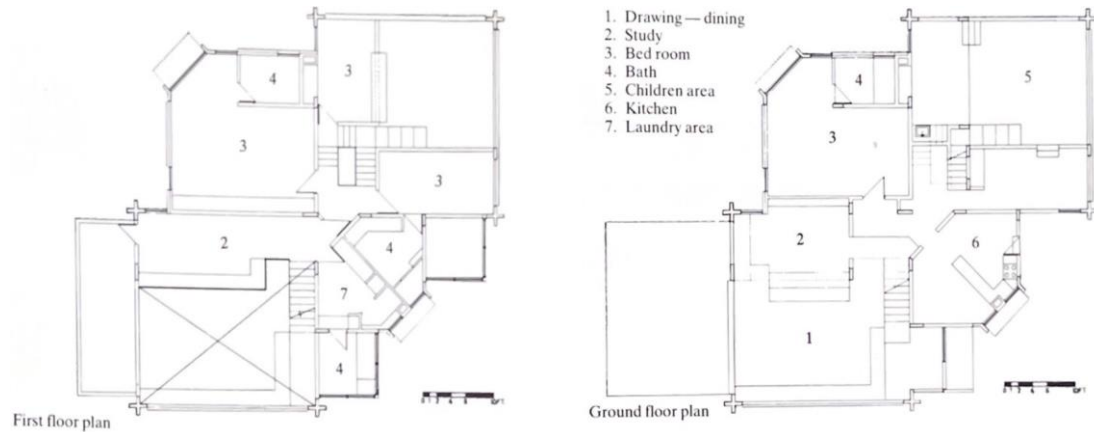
Grundriss Lari House (Quelle: Mumtaz, 1985, S. 173)
